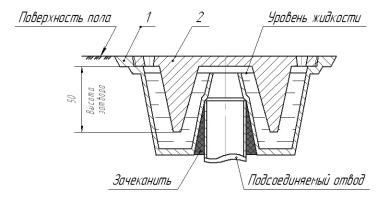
Схема установки трапа вертикального - 50/100 1 - Корпус; 2 - Решетка
